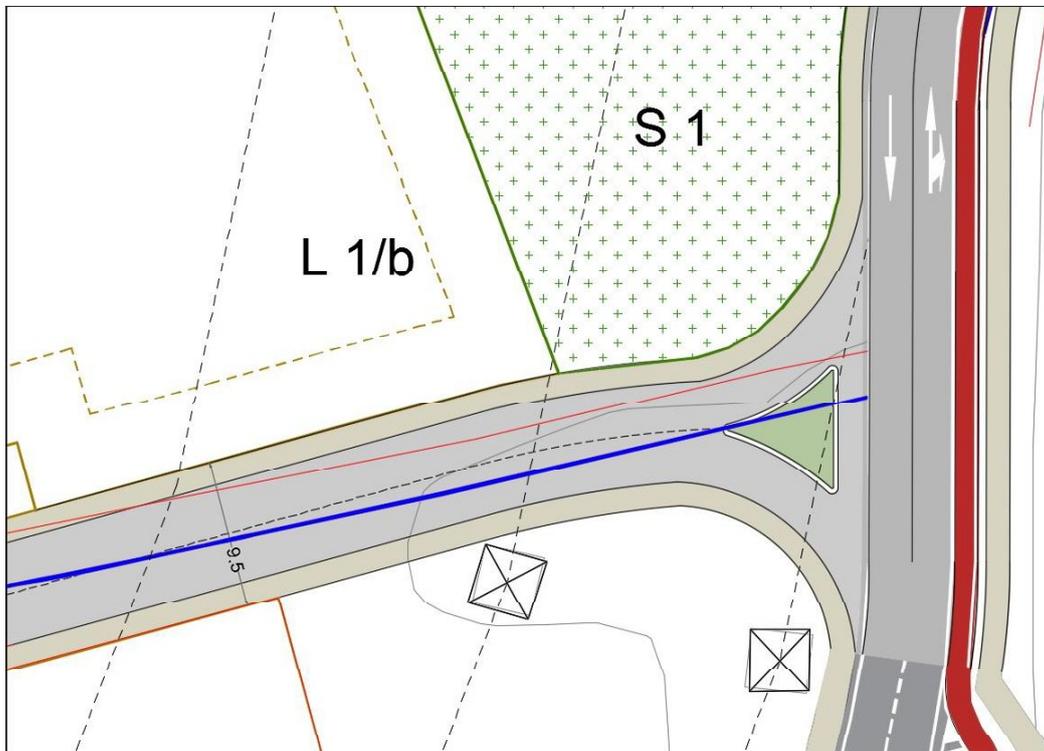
Strada D - Stralcio elaborato Planovolumetrico adottato.
